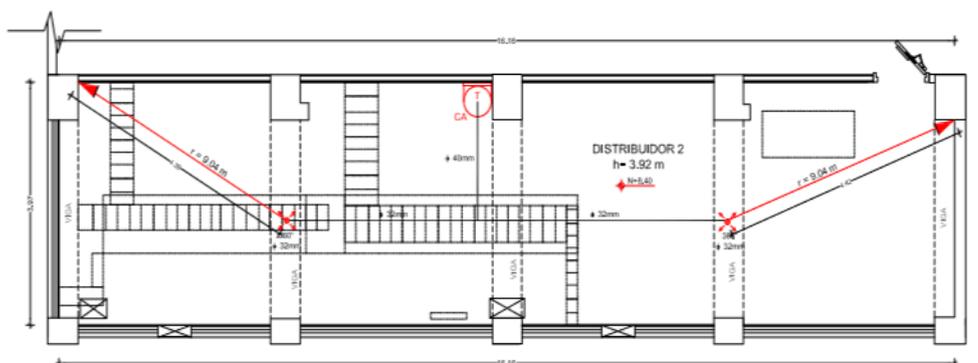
Plano de ubicación de tanque de agente limpio, tuberías y toberas de sala de Distribuidor 2
